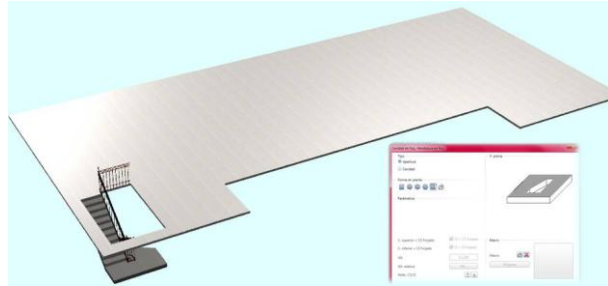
Animación del forjado de planta primera, donde aparece el hueco de escalera. (Elaboración propia; Allplan).
